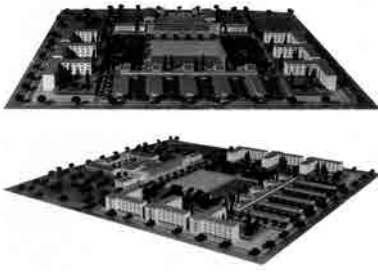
y Fig. 19 Vistas generales de la maqueta del proyecto construido. Fotografías de época.
